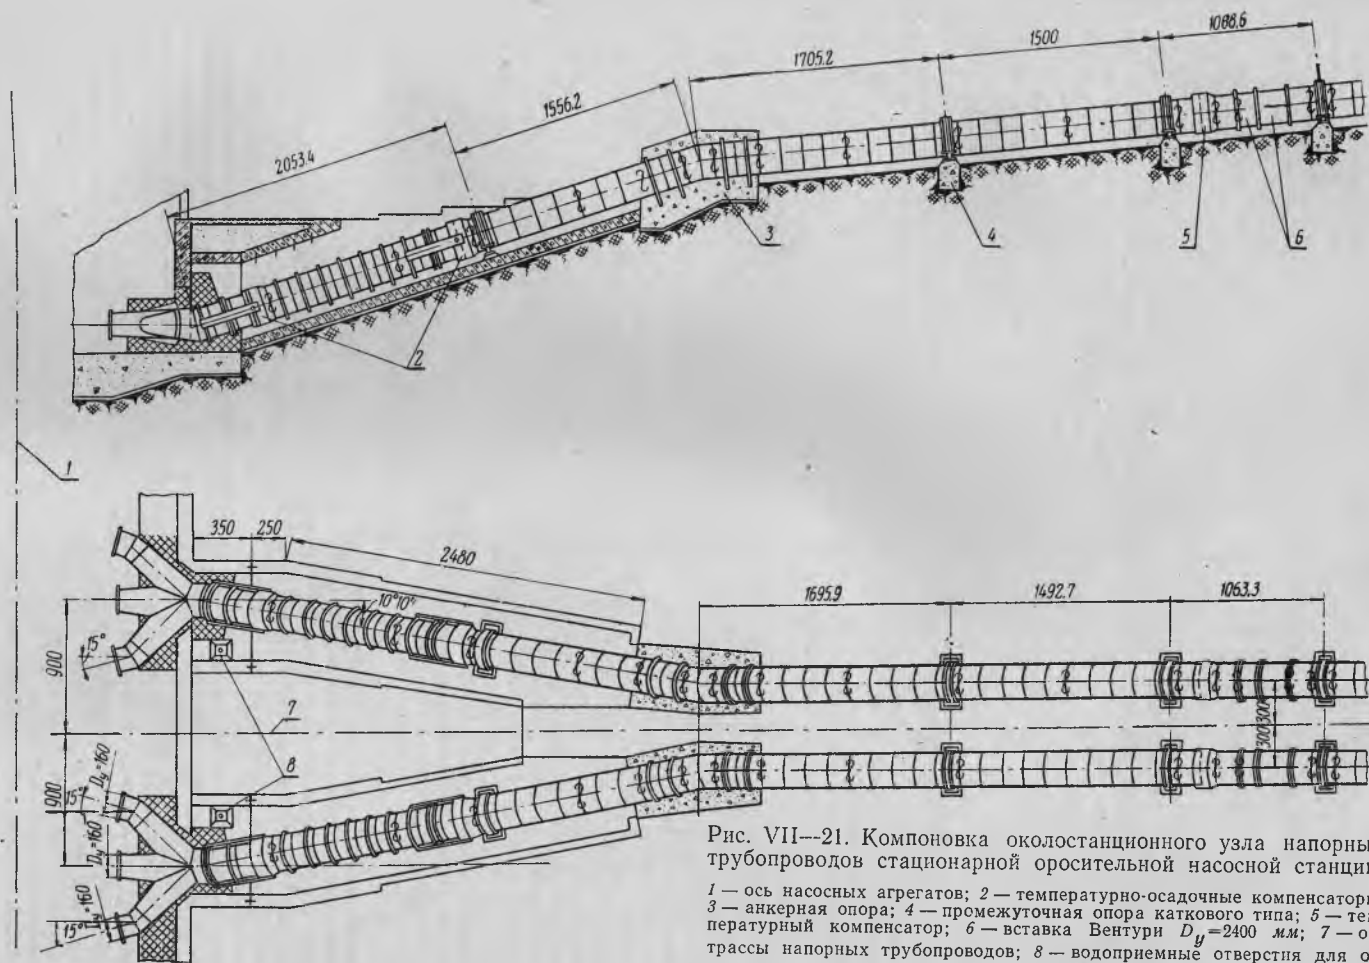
Компоновка околостанционного узла напорных трубопроводов стационарной оросительной насосной станции:
